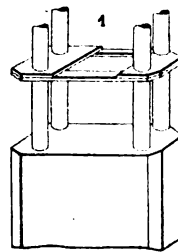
Z. A.: Armierte Betonkonstruktionen nach System Hennebique.
